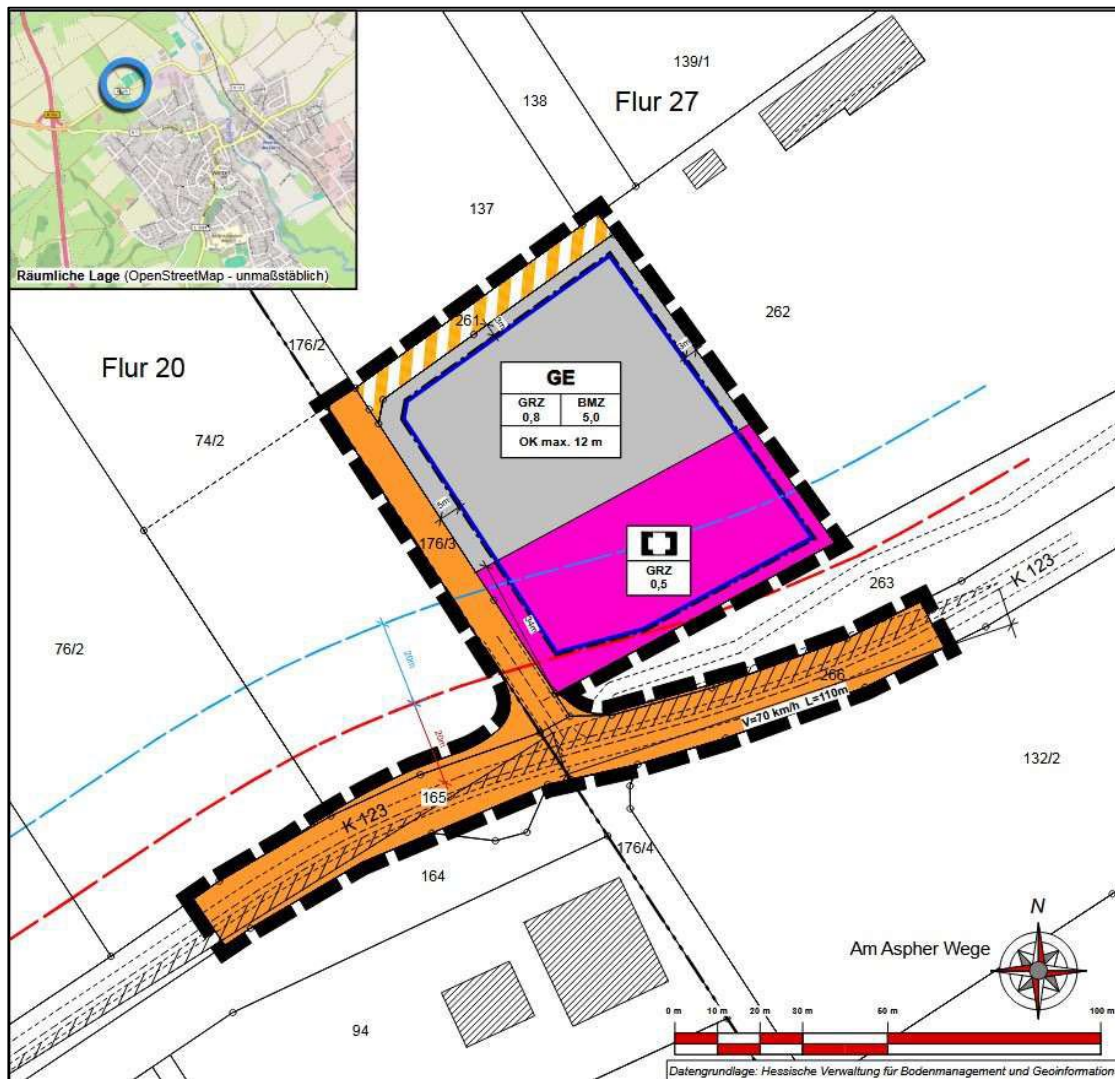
Bebauungsplan Nr. 33 „Steinwegswiesen“ 1. Änderung, (Stand: 08/2025). (Quelle: Umweltplanung und Städtebau Groß & Hausmann, Weimar/Lahn).
